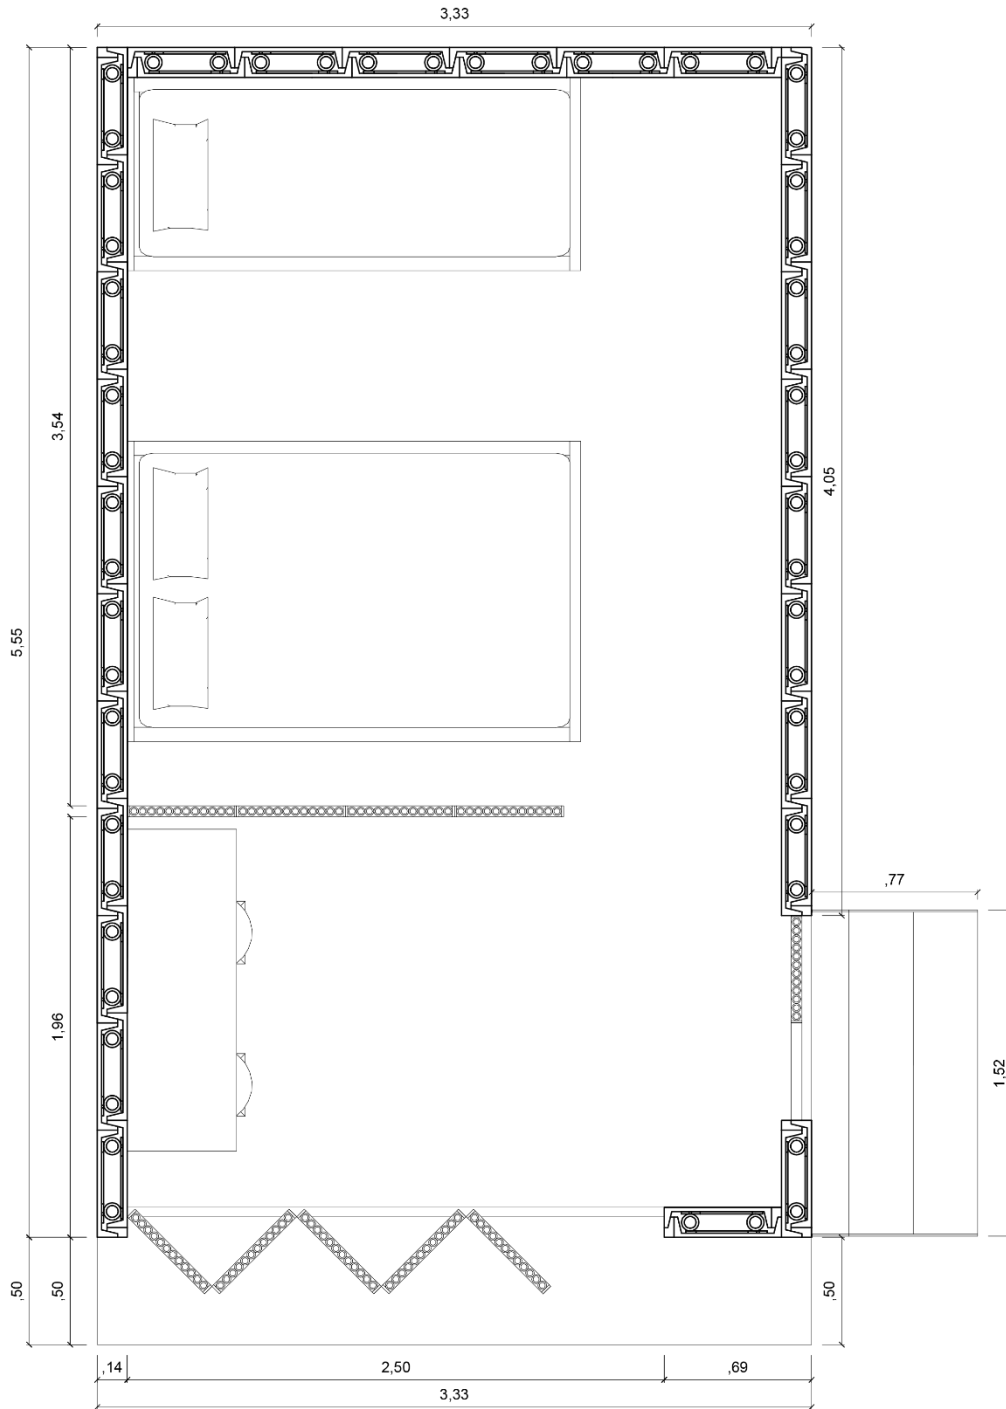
Planta baixa do abrigo proposto com cotas em metros.
